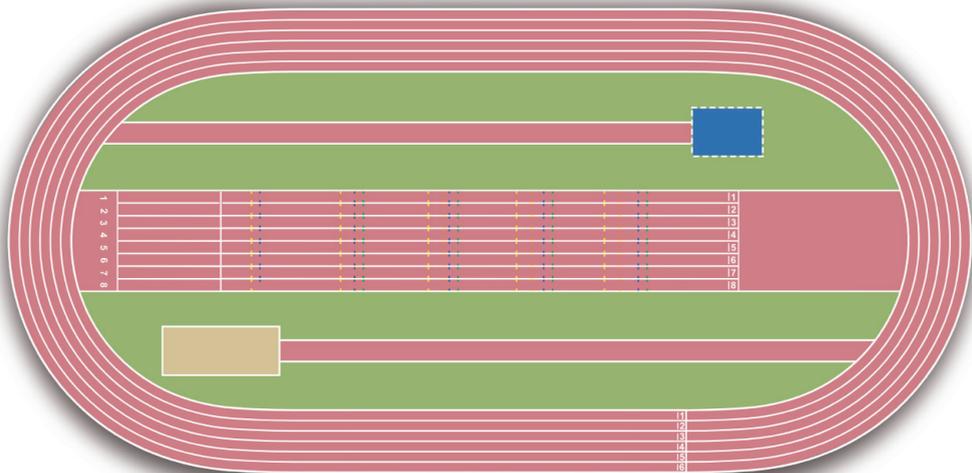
Plano de una pista cubierta de 200 m. de borde interior (IAAF, 2008).
